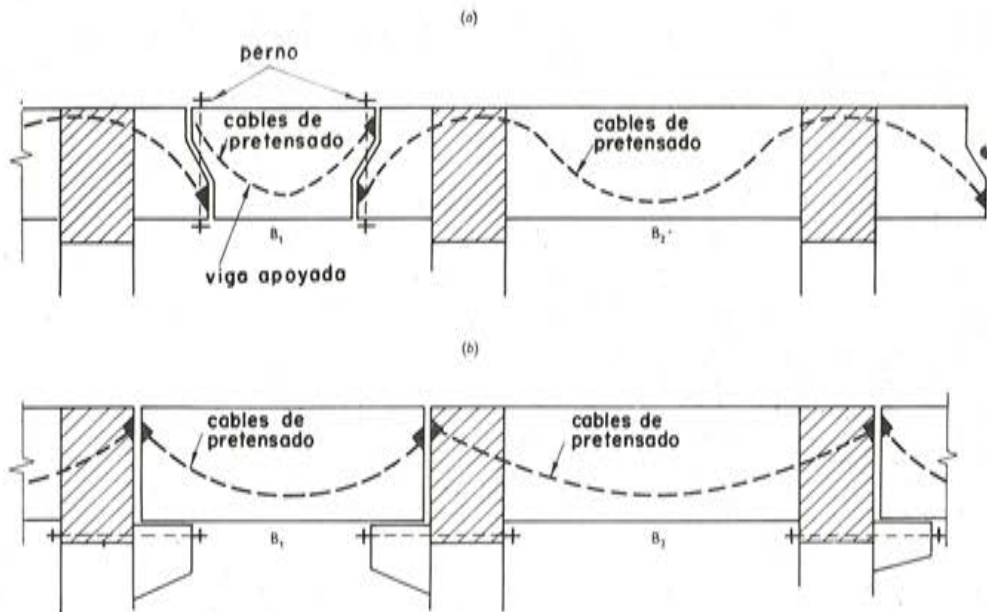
Viga secundaria a viga principal. Variantes para viga biempotrada o biapoyada.
